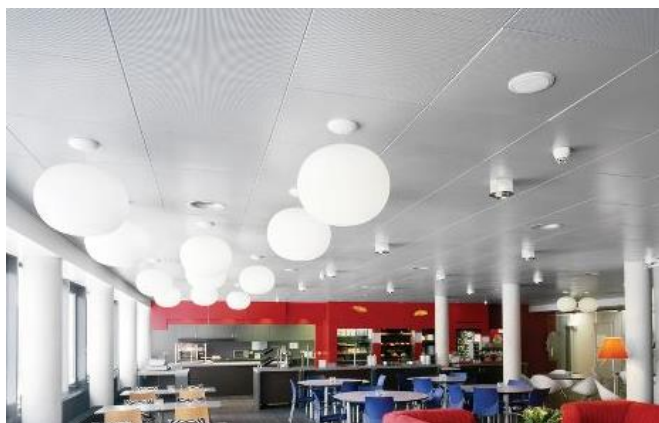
rrrrr. Falso techo metálico. Fuente: www.armstrong.es
